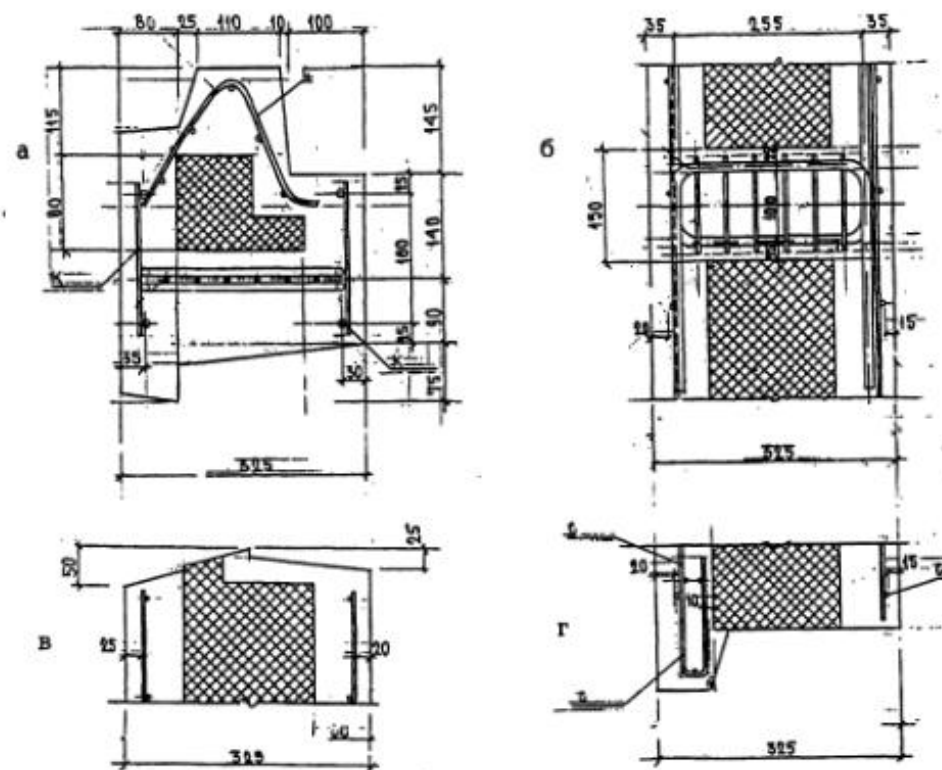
Детали сечений трехслойной панели со шпоночными связями: а - армирование стыкового гребня; б - то же, соединительной шпонки; в - подоконных зон; г - надоконных зон
